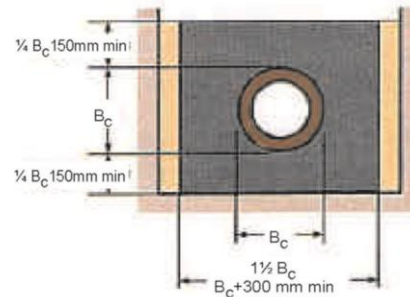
Zonë rrethuese me beton të përforcuar
